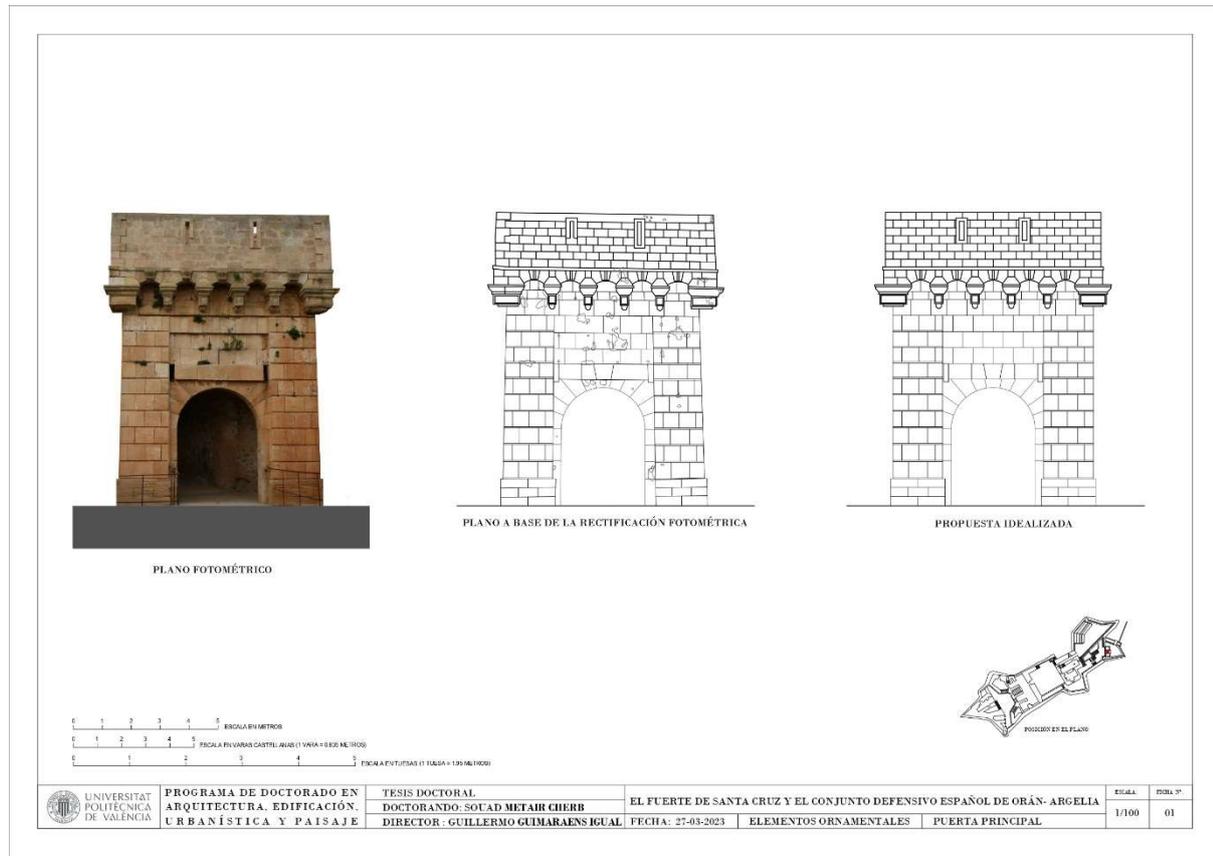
Ficha técnica que muestra la puerta principal del fuerte y sus dimensiones (S.M).
